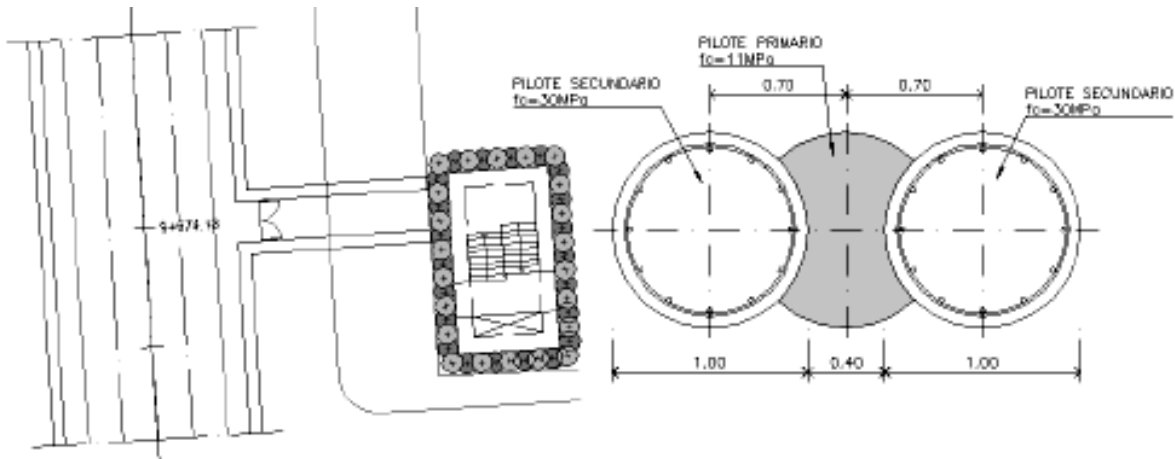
, Planta de Salida de Emergencia y dimensión de pantalla de pilas (SENER, 2014)
